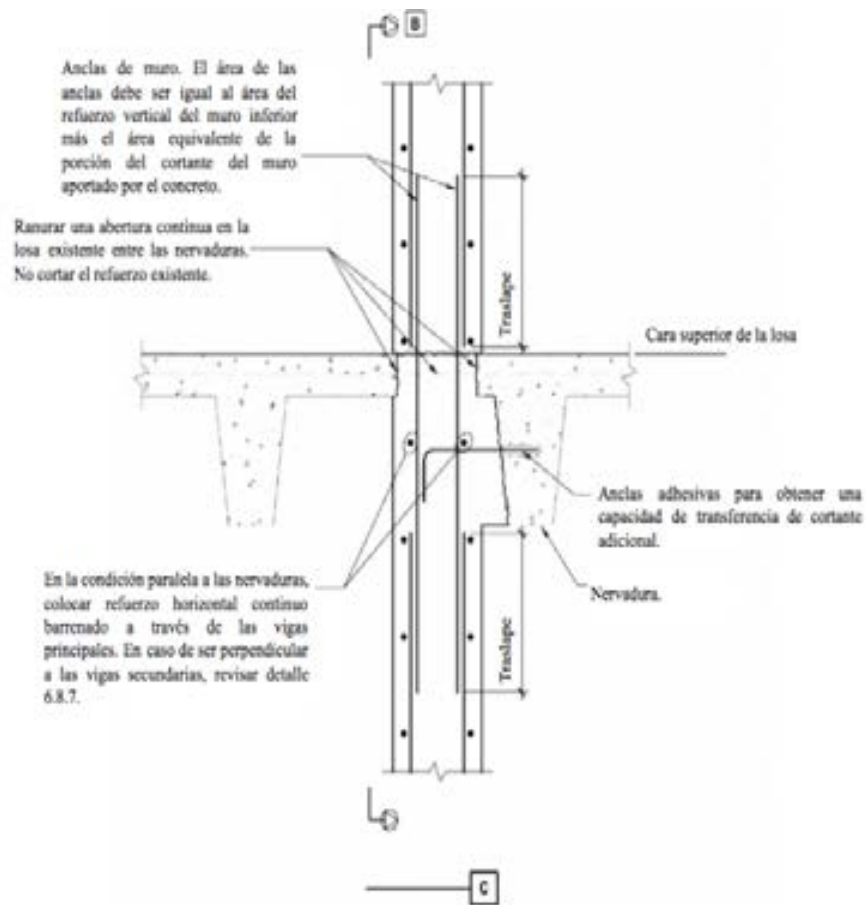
Conexión de un muro en edificios con losas nervadas en la dirección paralela al muro (FEMA 547)
